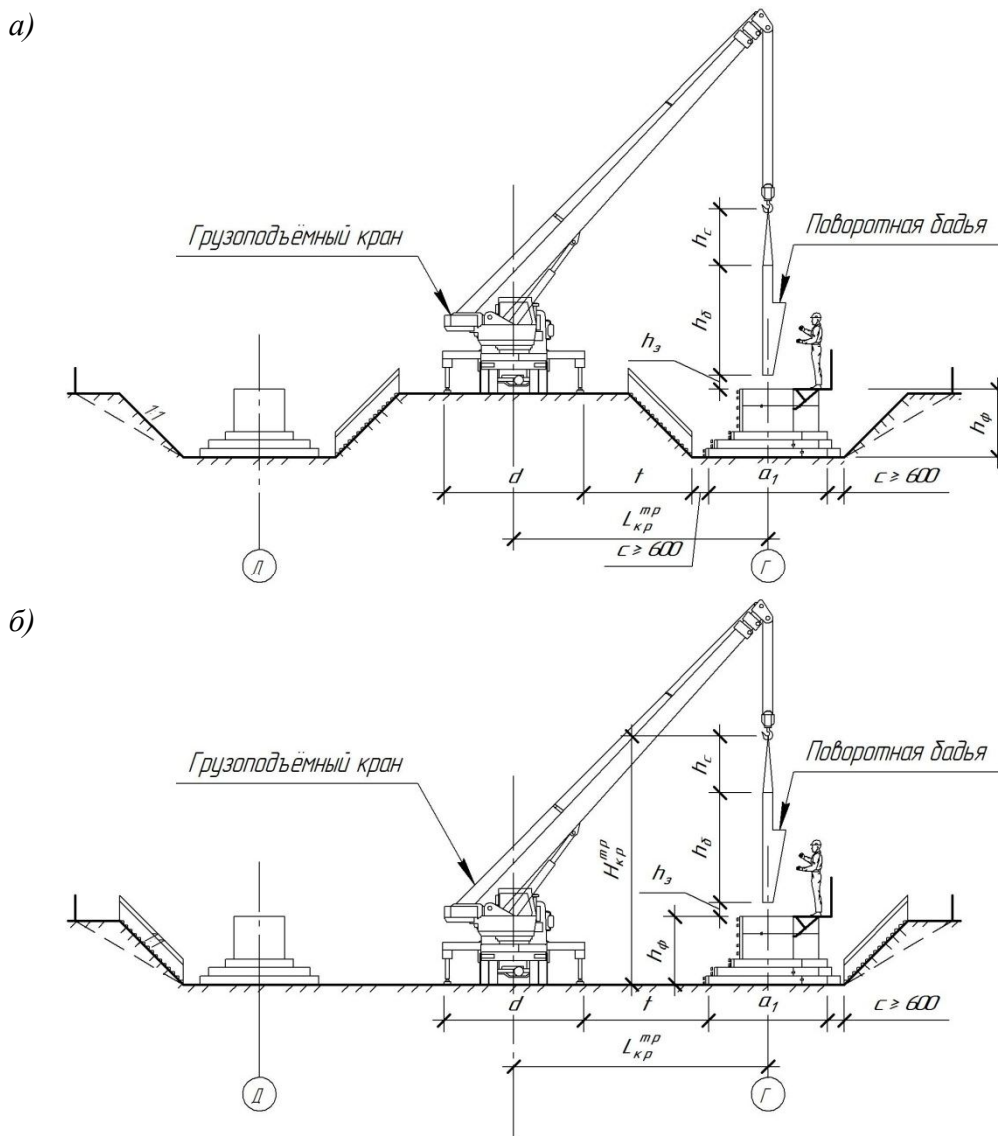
Схема бетонирования фундаментов по схеме «кран – бункер»: а – кран располагается на бровке; б – кран располагается в котловане
